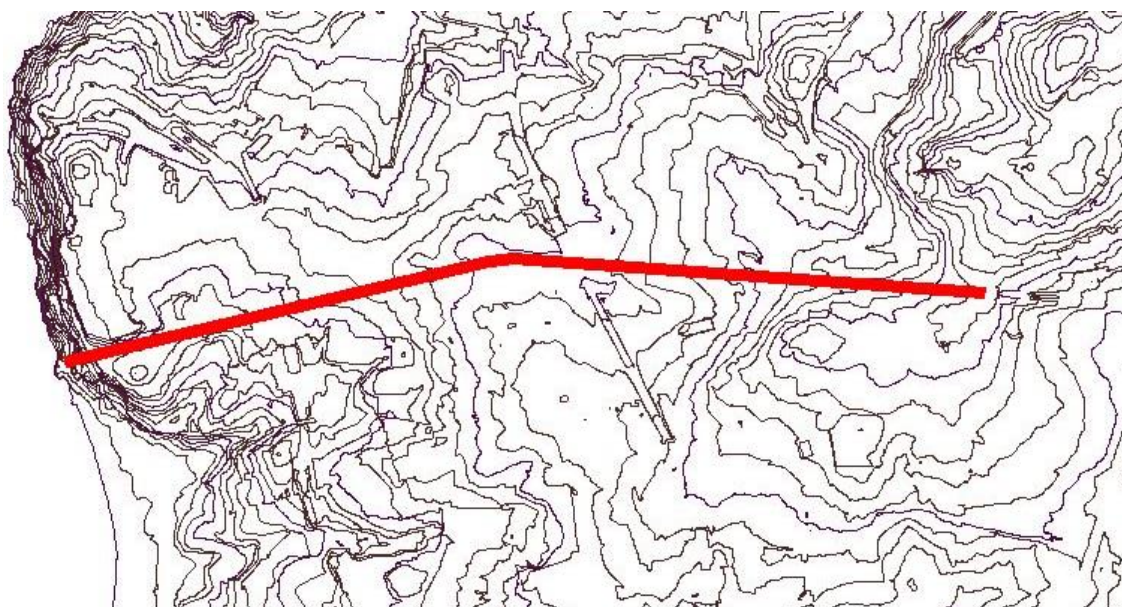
| Esquema da implantação da Avenida sobre planimetria de 2012
